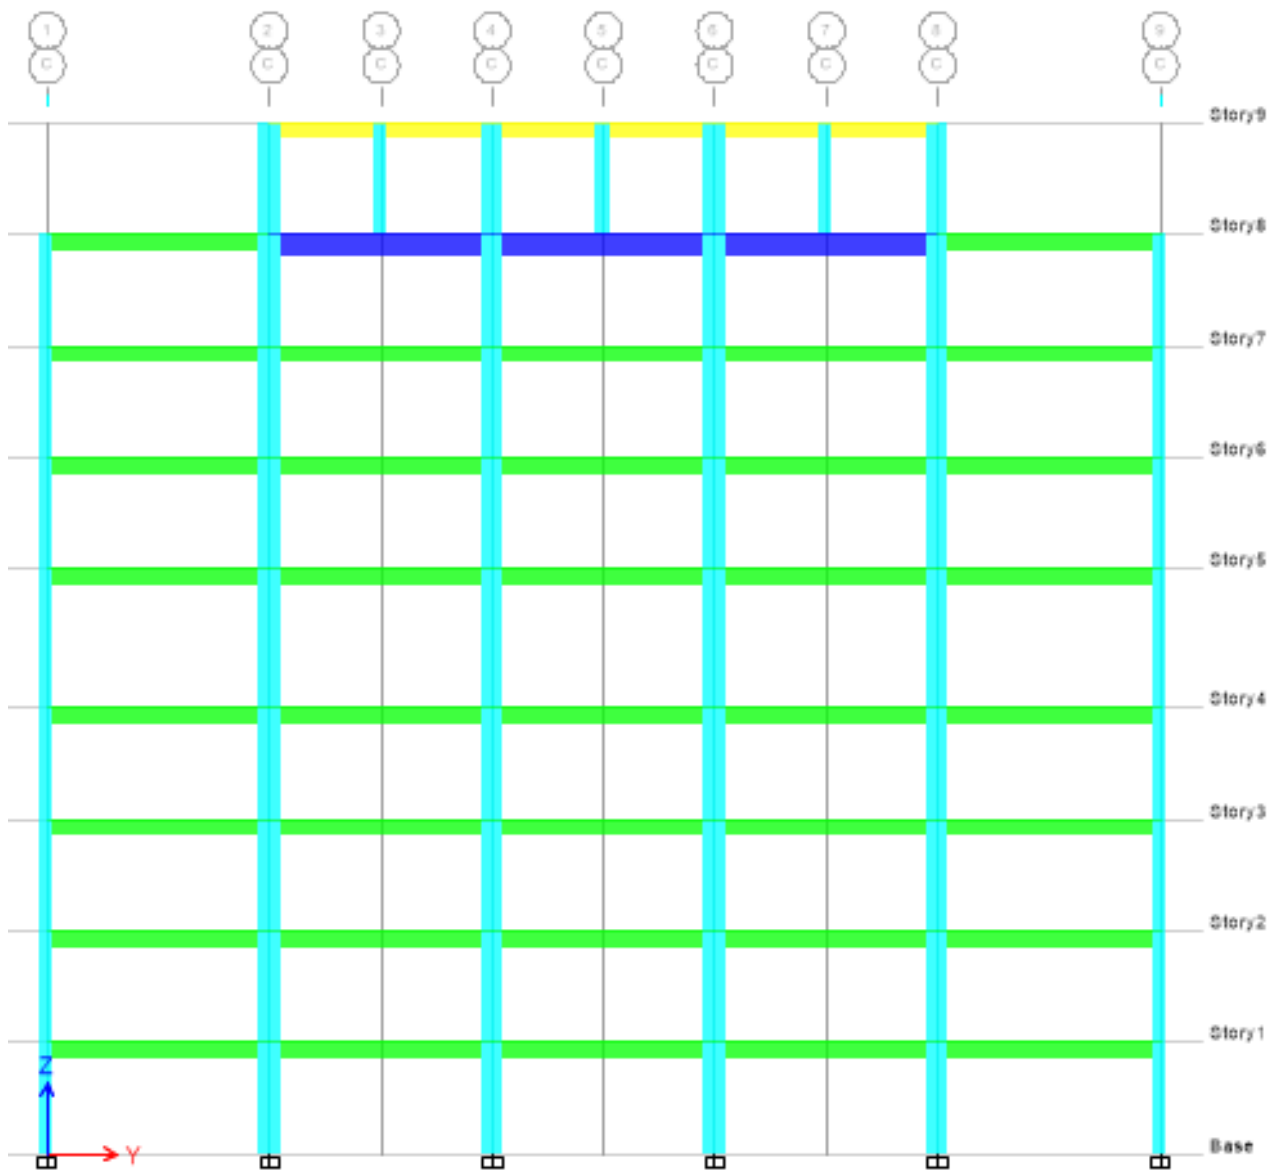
Denah Model 3 Lantai 1 – Lantai 7 dengan *Seaworld* di Lantai 8
